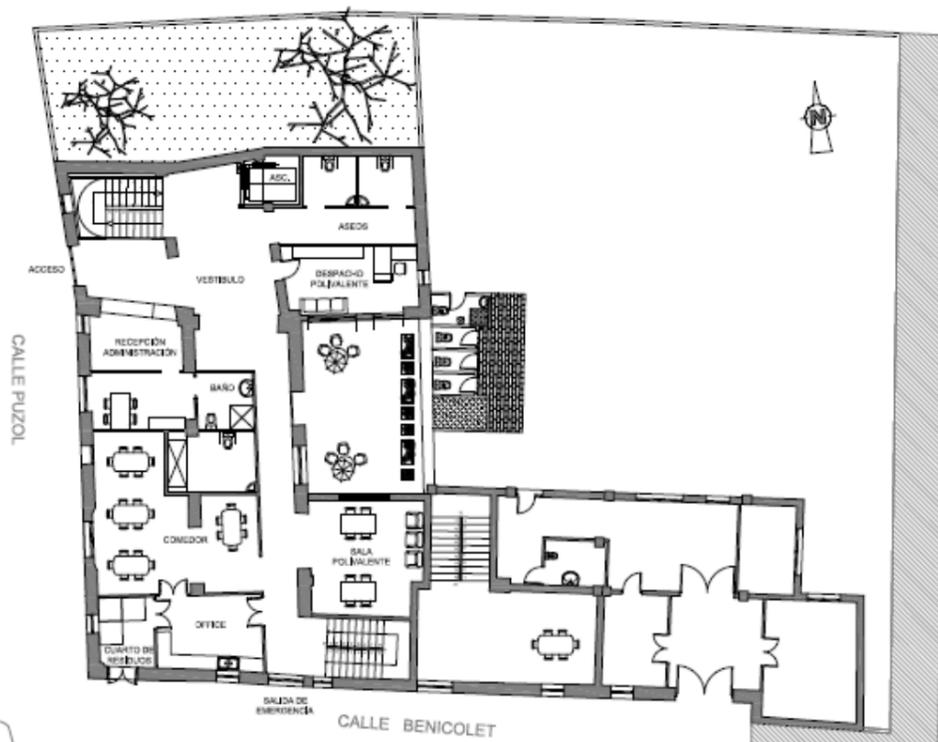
Distribución Planta Baja Centro de Día (Propia)
